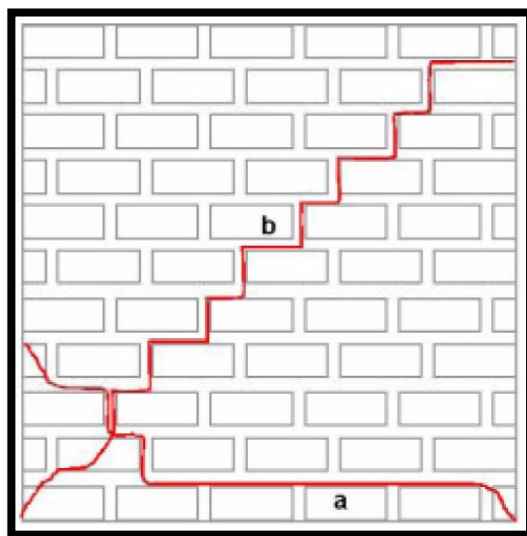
Agrietamiento por fallo a cortante en muros de mampostería no reforzada.
